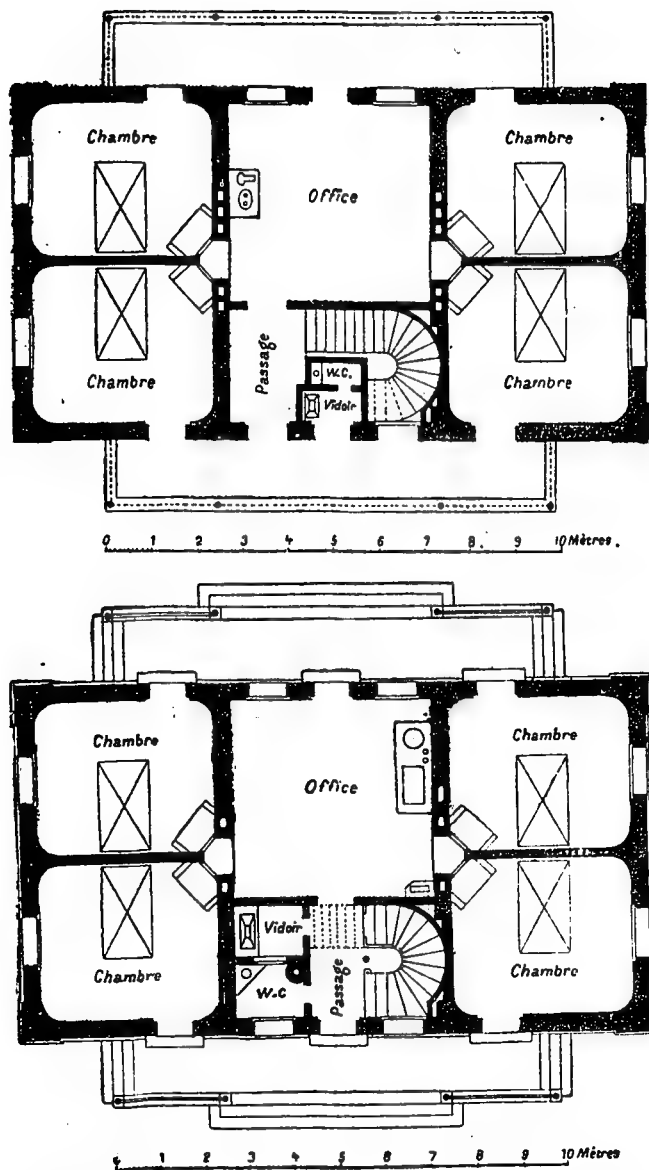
Pavillon Tarnier à la Maternité de Paris; plan du rez-de-chaussée (en bas) et de l'étage (en haut).
